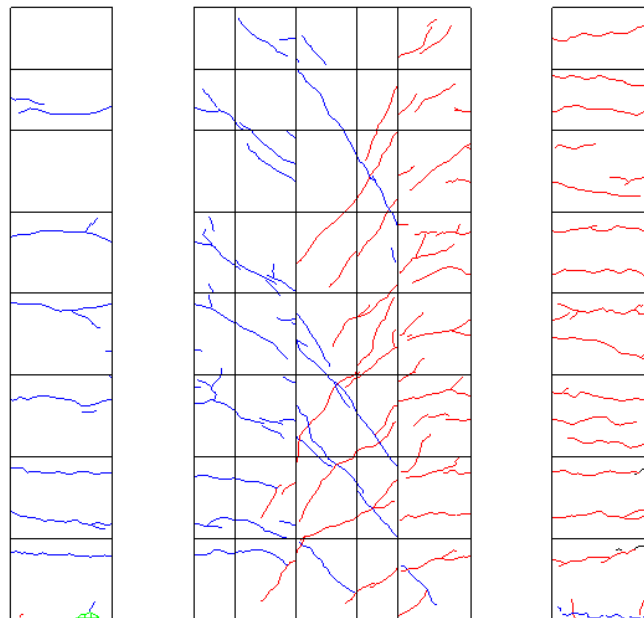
R=-1/100②ひび割れ図
